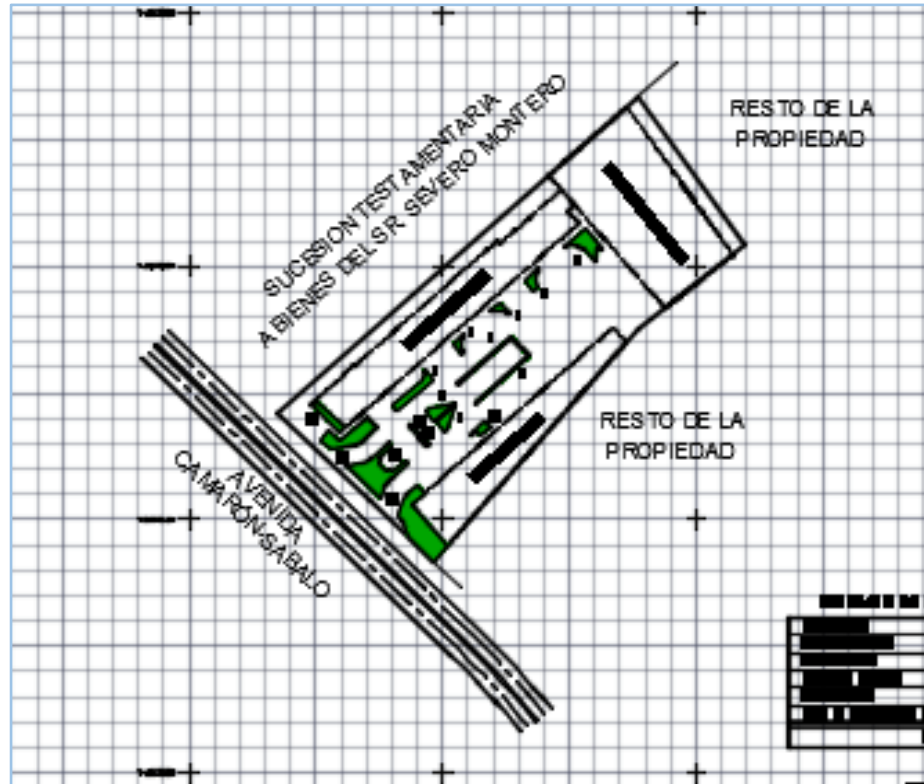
Área del terreno. Plano anexo hoja 4 de 5
